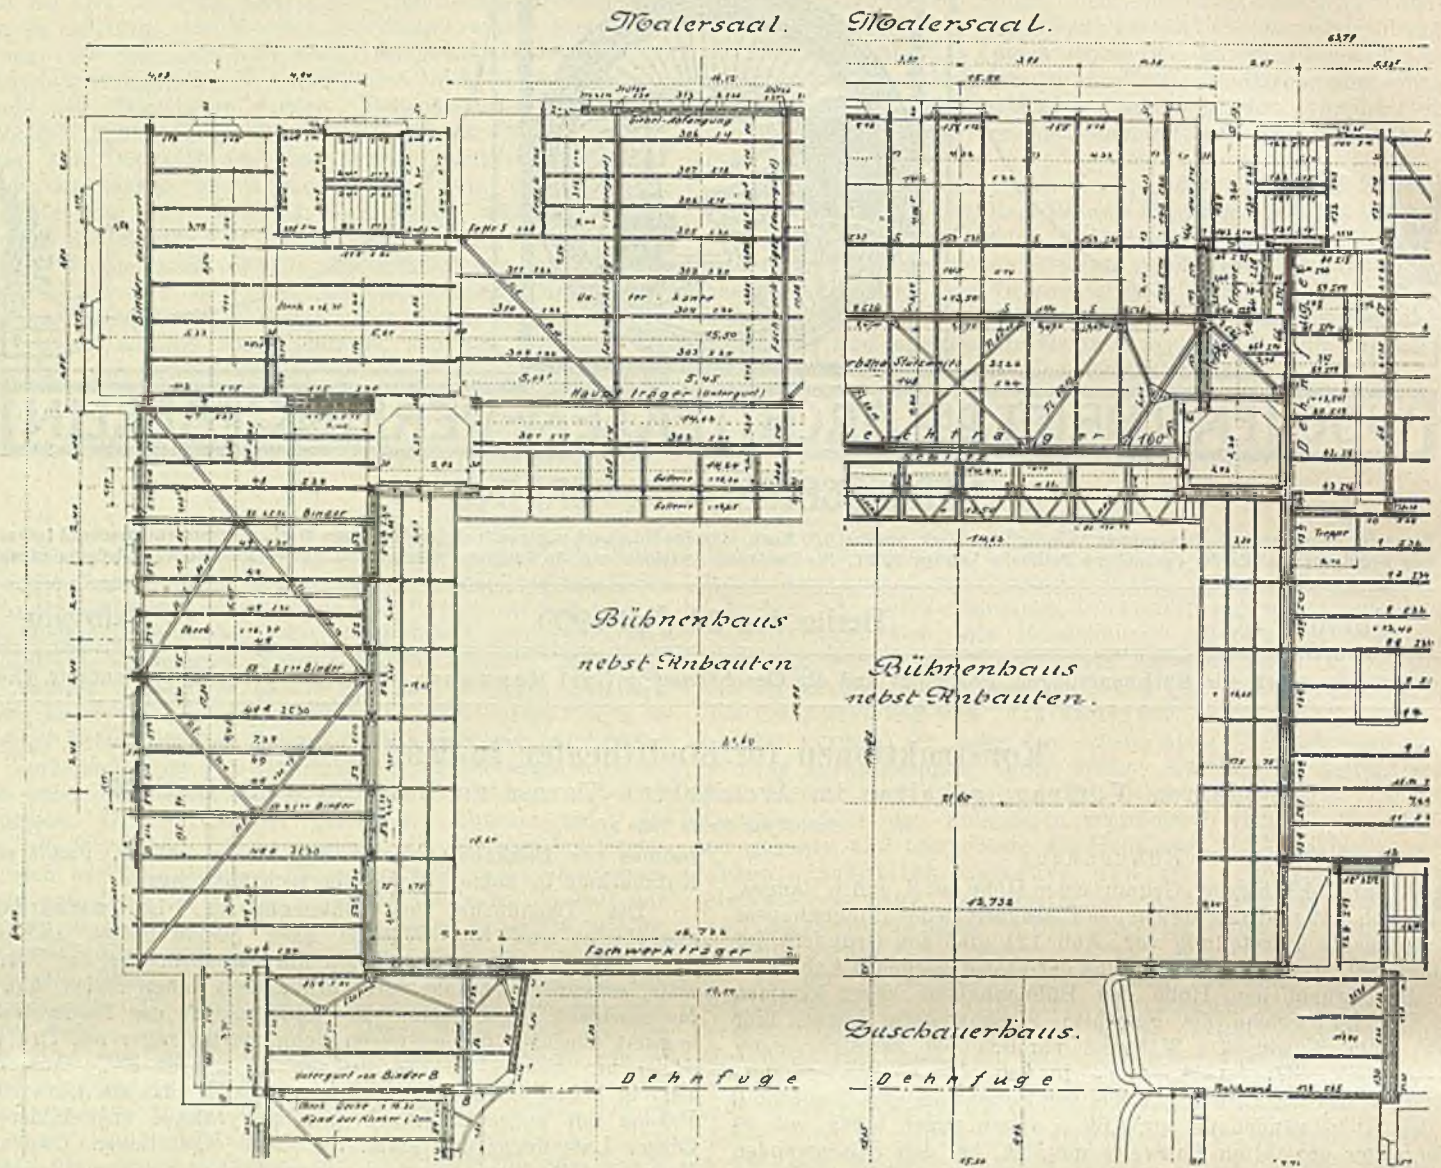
und 118. Grundrisse des Bühnenhauses in Höhe des 2. und 1. Ranges
